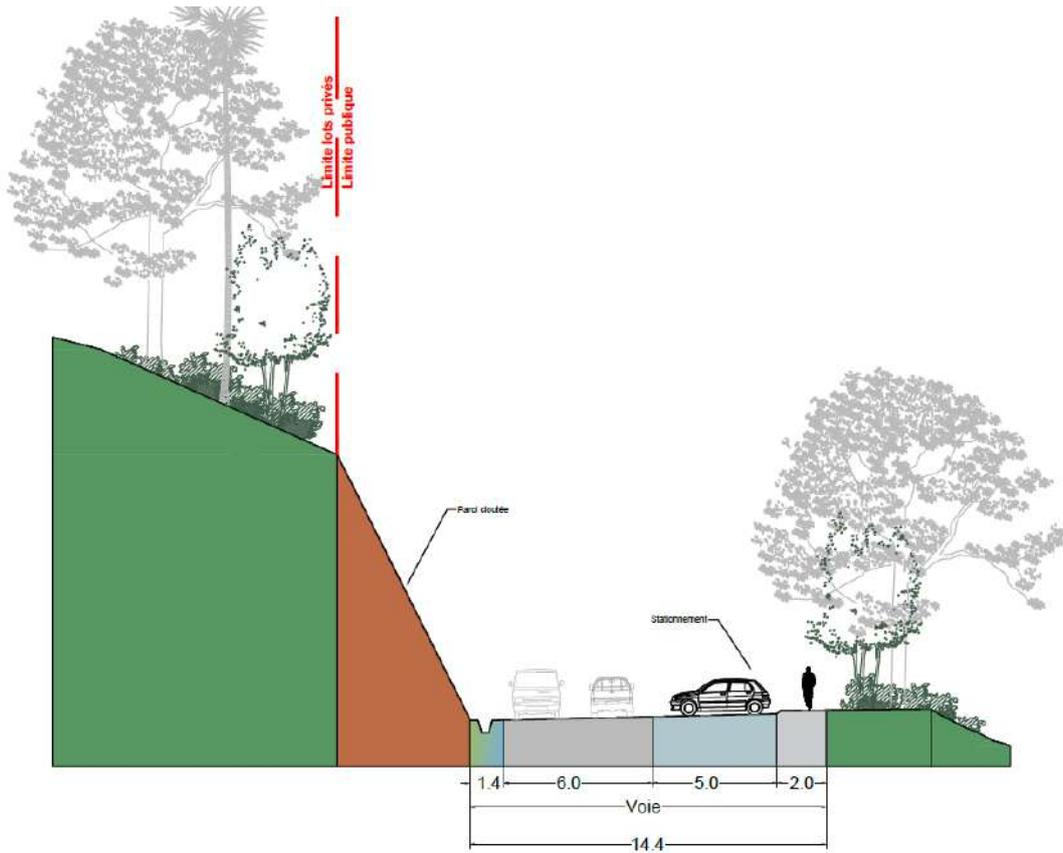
Profils en travers type de la route de la crête (avec stationnements)
